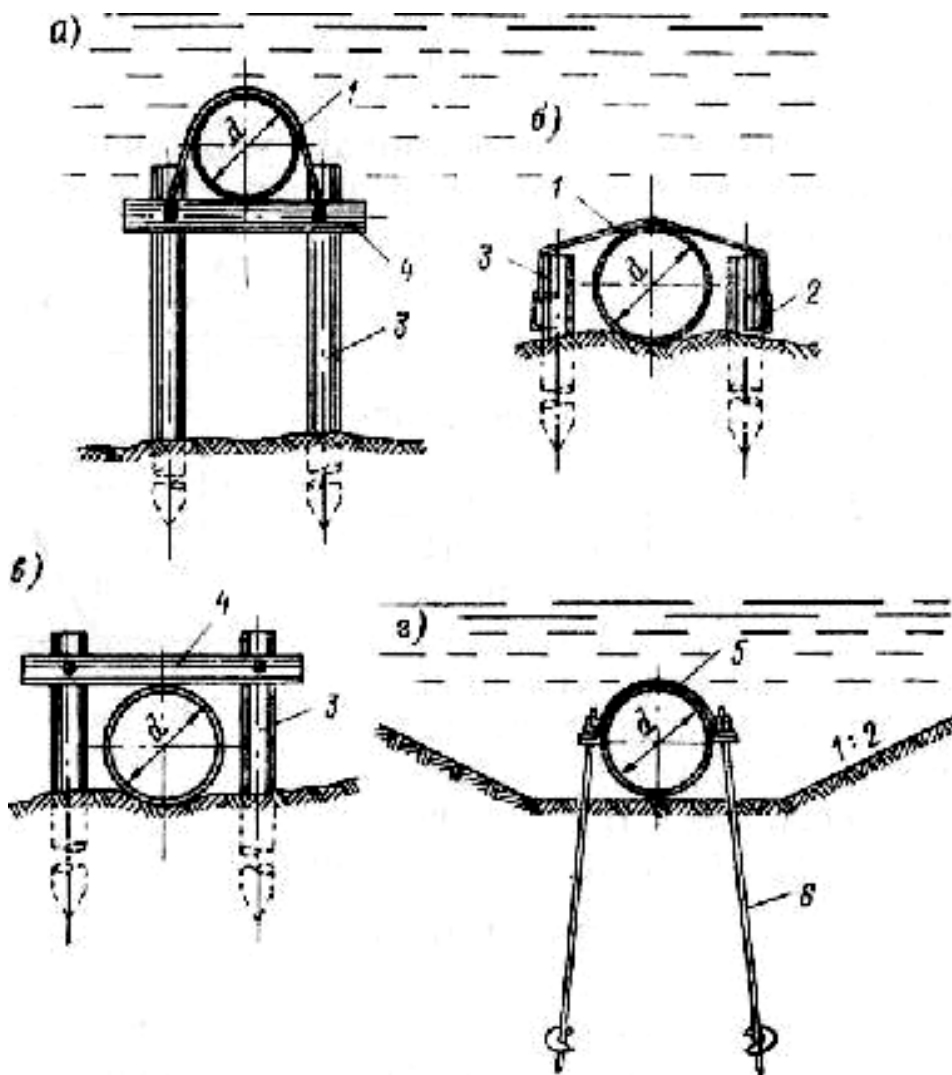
Кріплення підводних трубопроводів: а, б і в – на палях; г – анкерами (1 – трос; 2 – скоби; 3 – палі; 4 – поперечка; 5 – хомути; б – сталеві анкери з лопатями)
